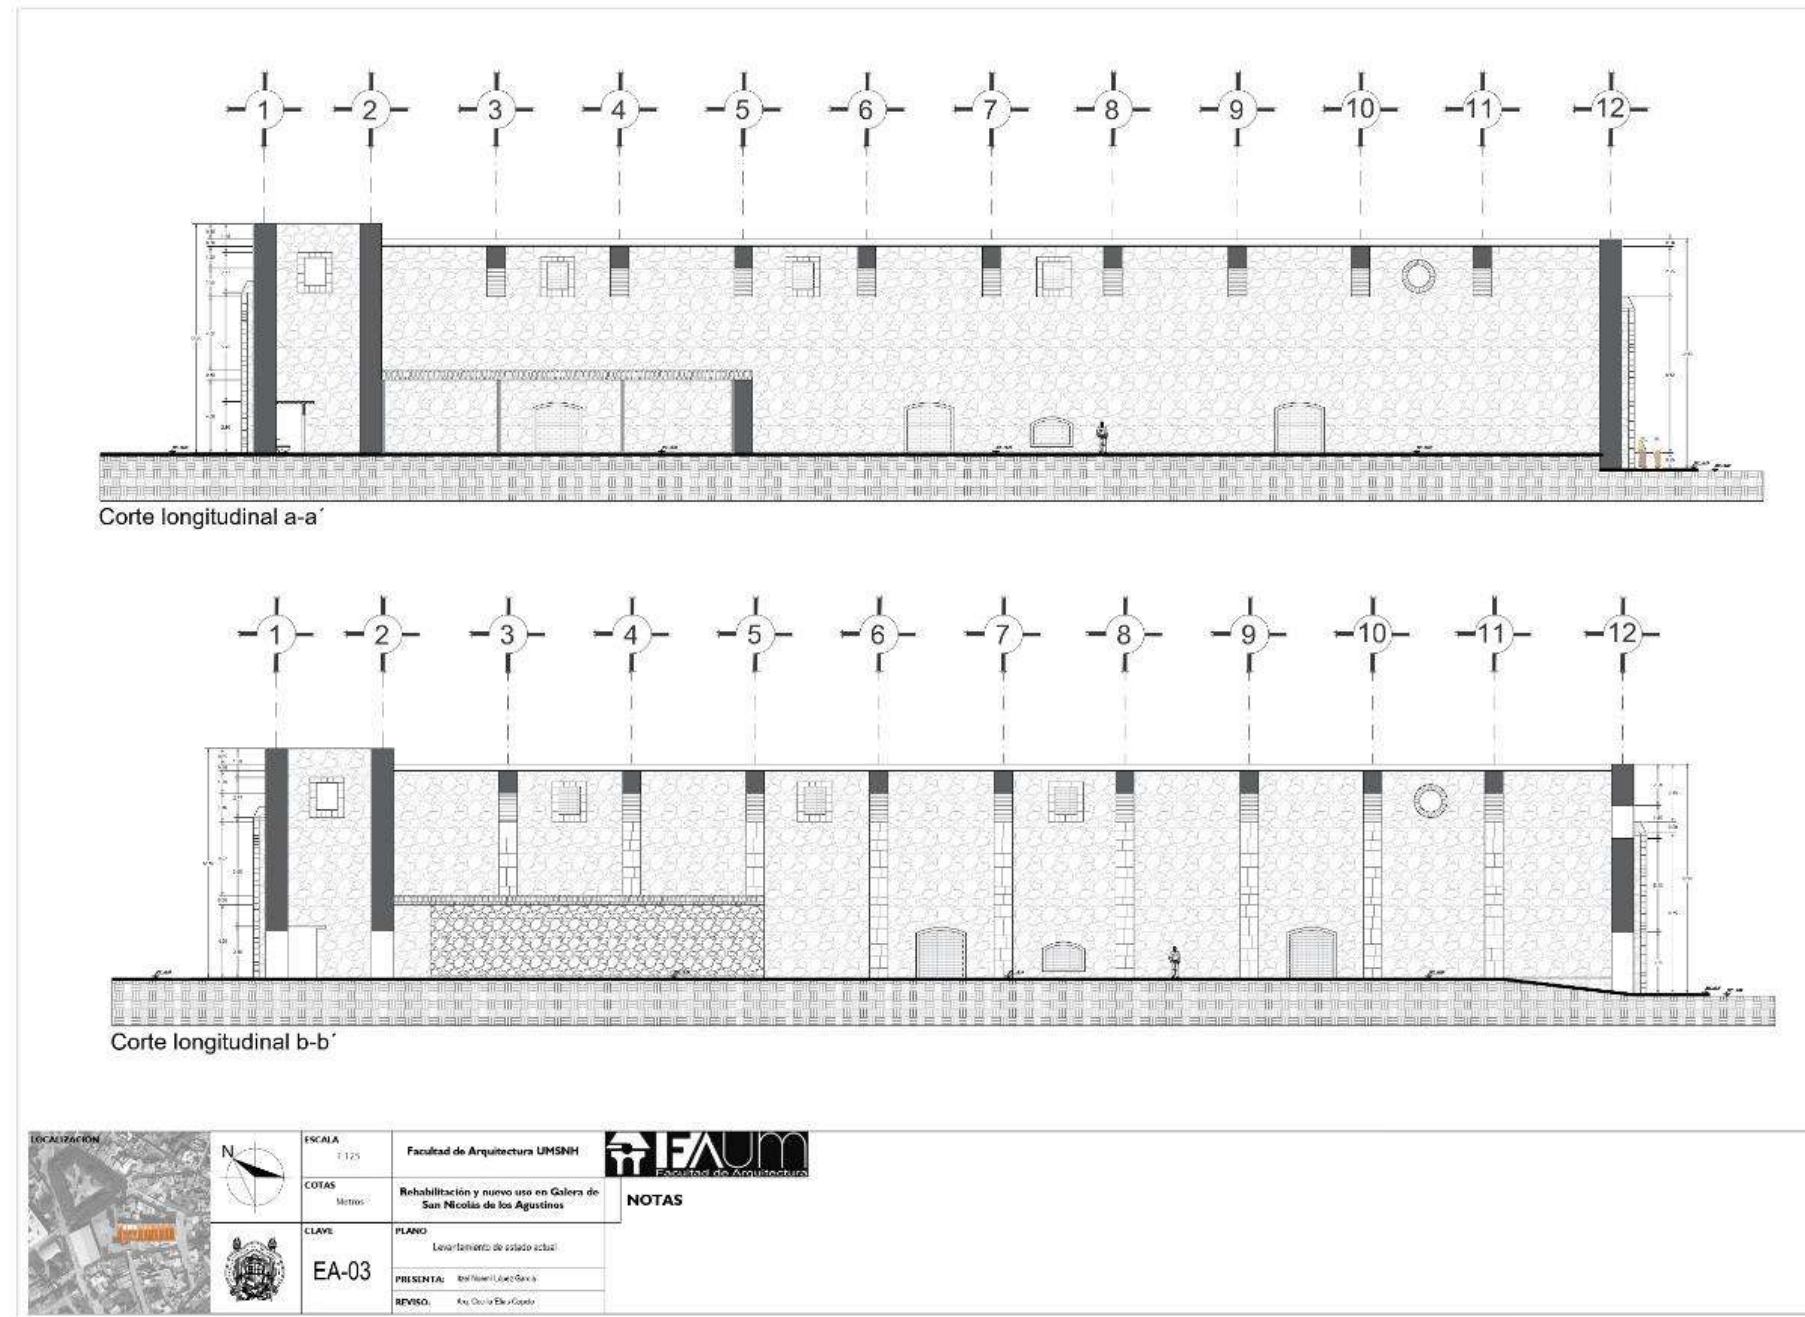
Plano estado actual 3. Fuente: Elaboración propia.
